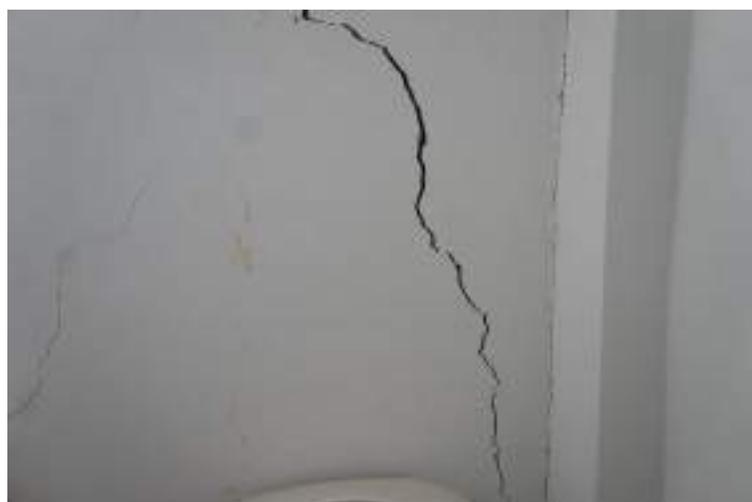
Fisuras en muros del interior de la casa.
